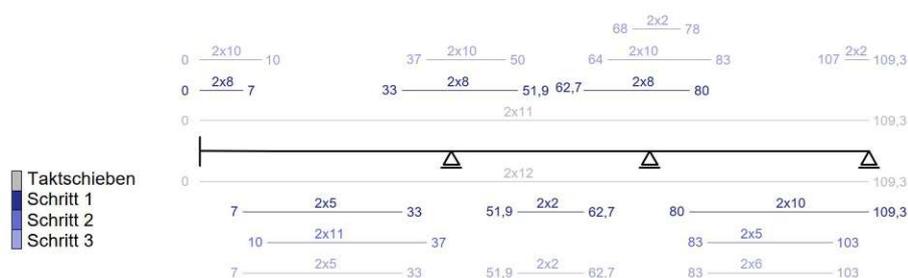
Vorspannung Betonagevariante A aus [1]
